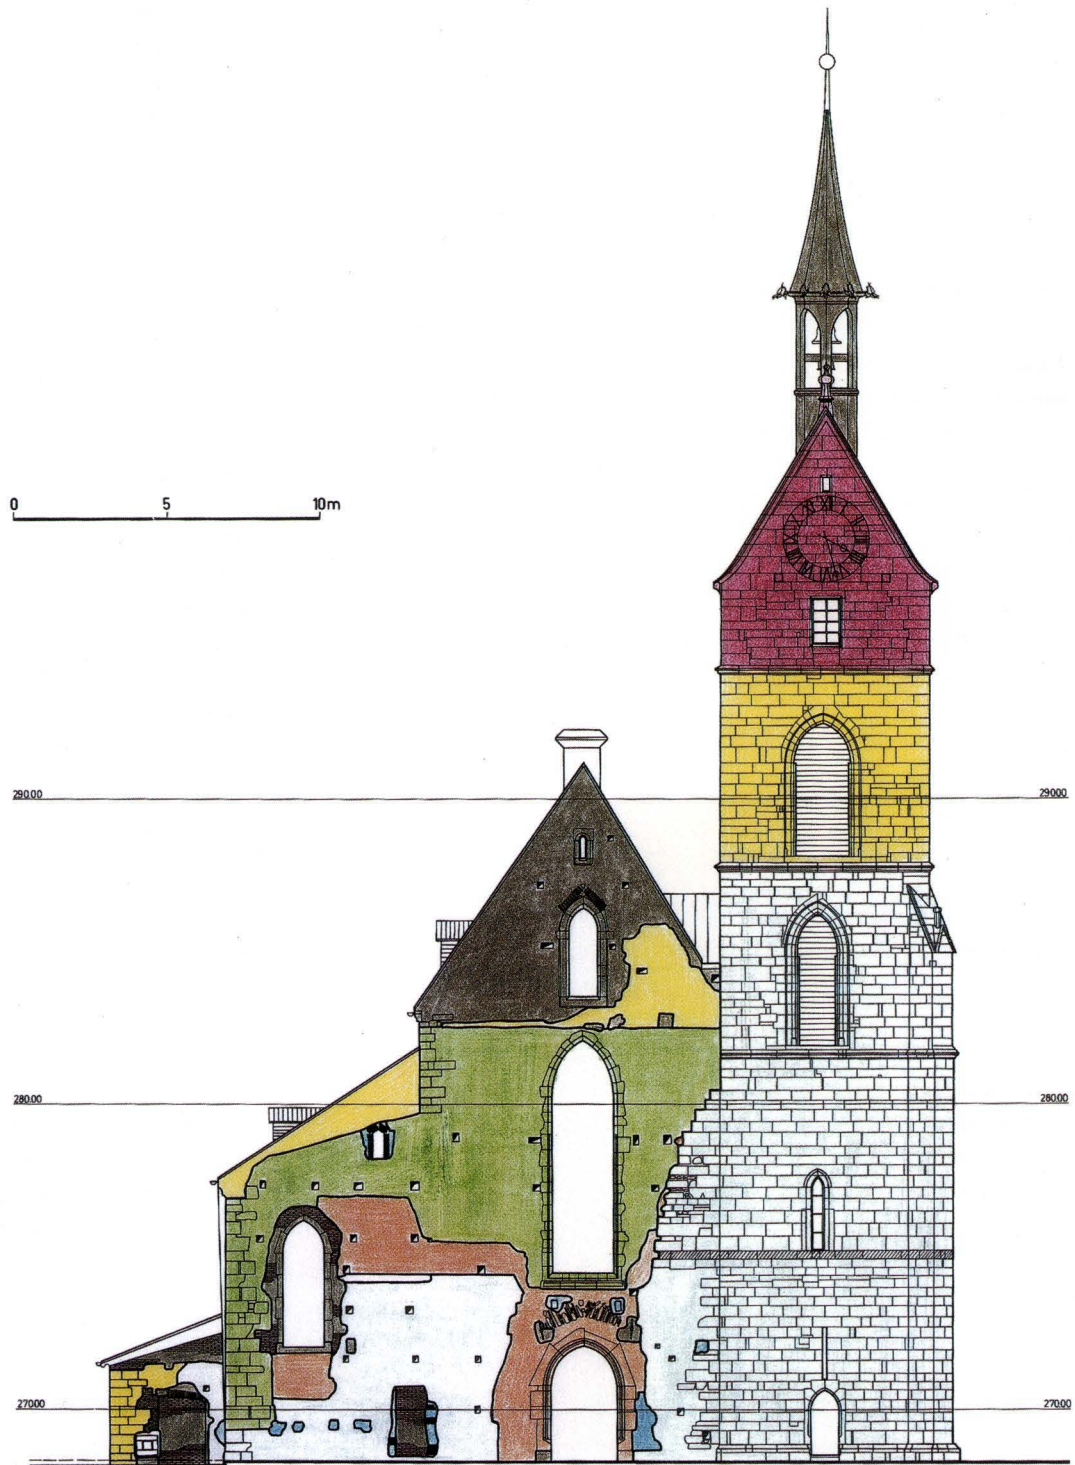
Martinskirche. Westfassade mit den Bauphasen. – Massstab 1:250.
